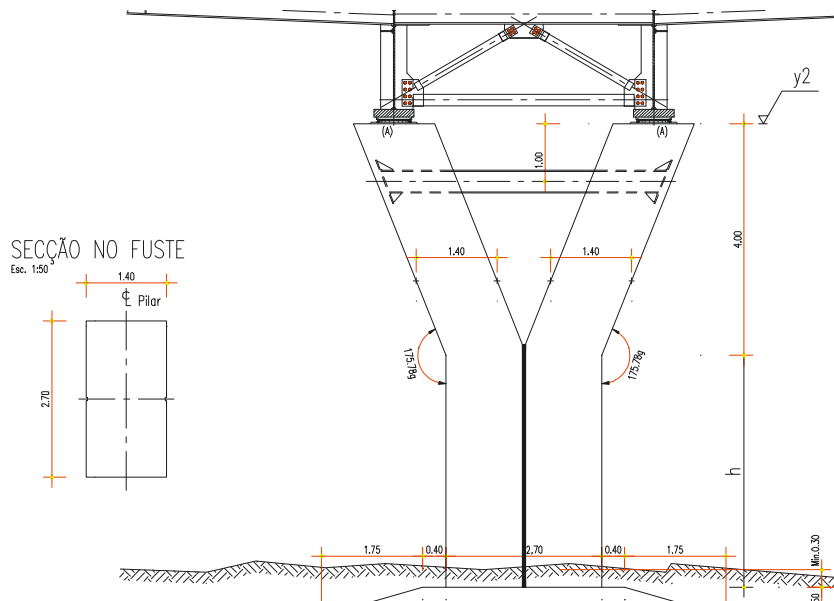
Pilares do viaduto (Sousa et al., 2006).
